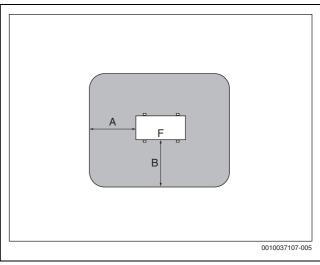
Volume de protection pour la mise en place au sol sur le terrain ou le toit
